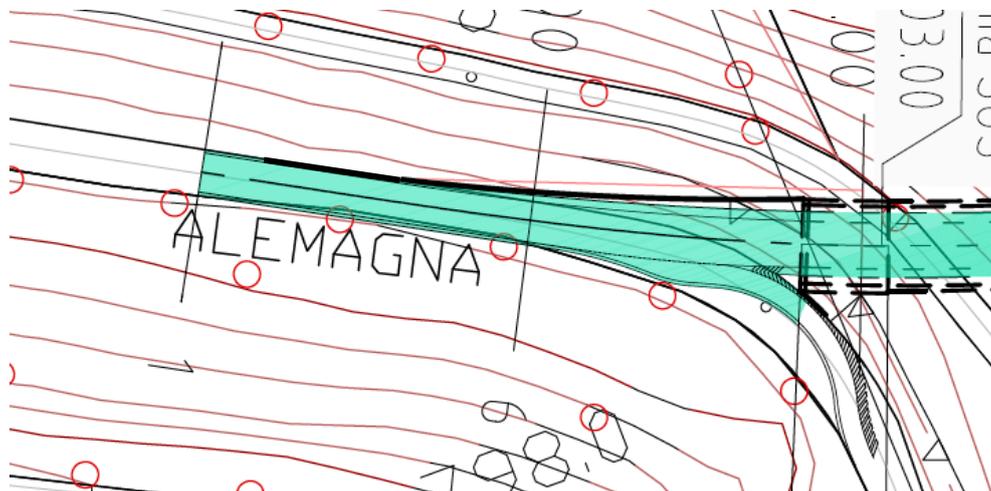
Muro di controripa tratto Ovest di fine lotto in continuità a portale di imbocco della galleria: prospetto
